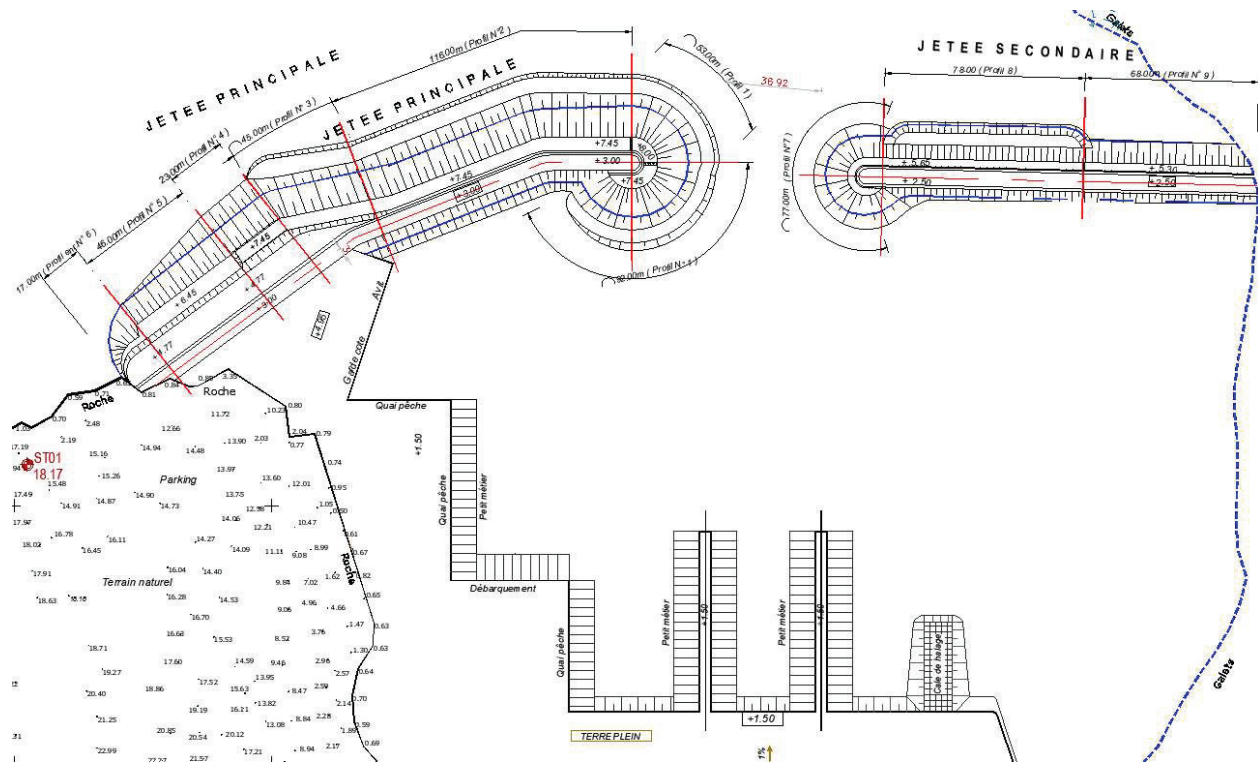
Plan de masse de la variante 1 d'aménagement
